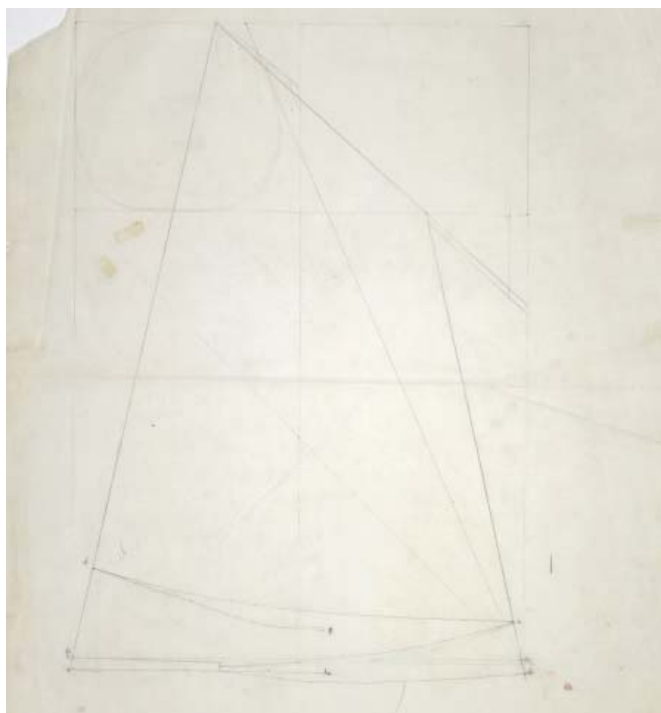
Dibujo base para elaboración de la sección este-oeste y fachadas oeste y sur. Fuente: FLC. 16635
